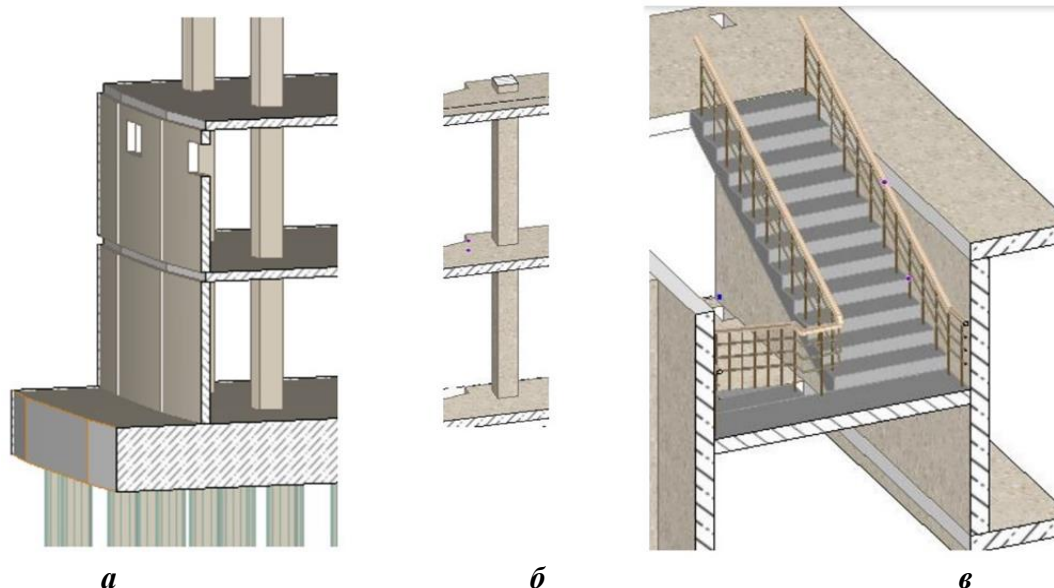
Конструктивні елементи в ПК САПФІР: *а* - влаштування стін цокольного та підвального поверхів; *б* - влаштування колон; *в* - типове влаштування сходових маршів і площадок
